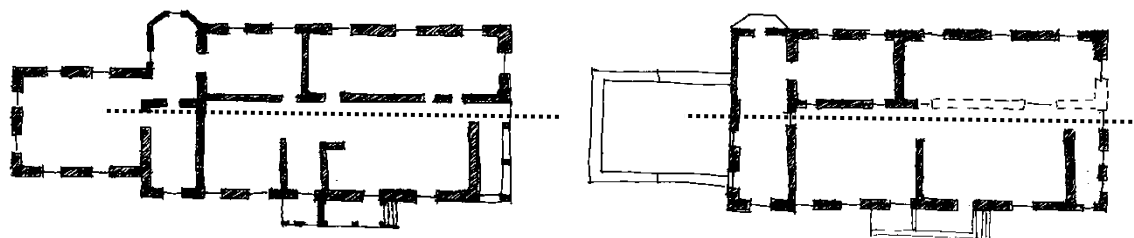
Plantas esquiço do Levantamento métrico do edifício, Rés-do-chão e primeiro piso, respetivamente.
